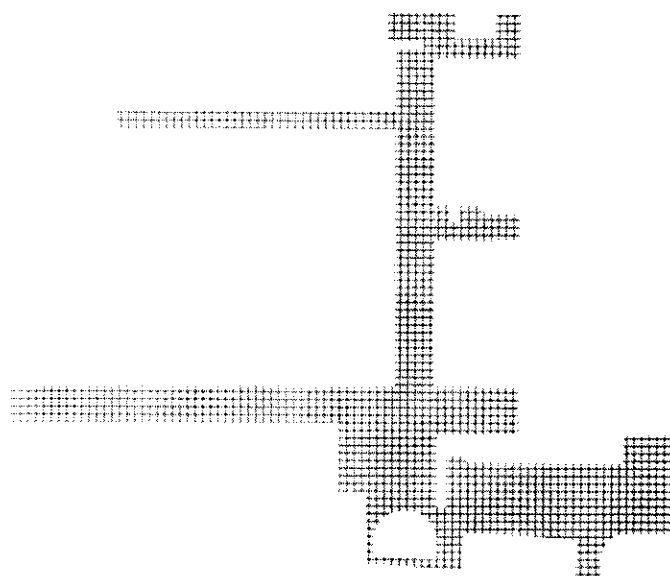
Planimetría Situación Propuesta – Balneario Municipal.
